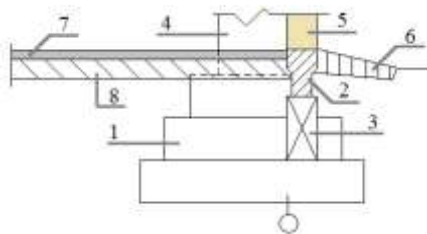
Монолитный столбчатый фундамент: 1 – фундамент, 2 – сборная фундаментная балка, 3 – бетонный столбик, 4 – колонна, 5 – наружное стеновое ограждение, 6 – отсыпка, 7 – бетонное покрытие пола, 8 – бетонный подстилающий слой.
